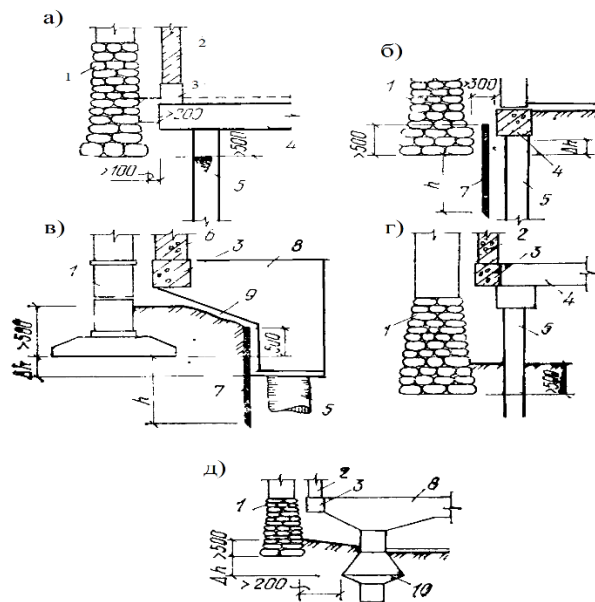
Примикання до існуючих фундаментів палювих фундаментів будівель
